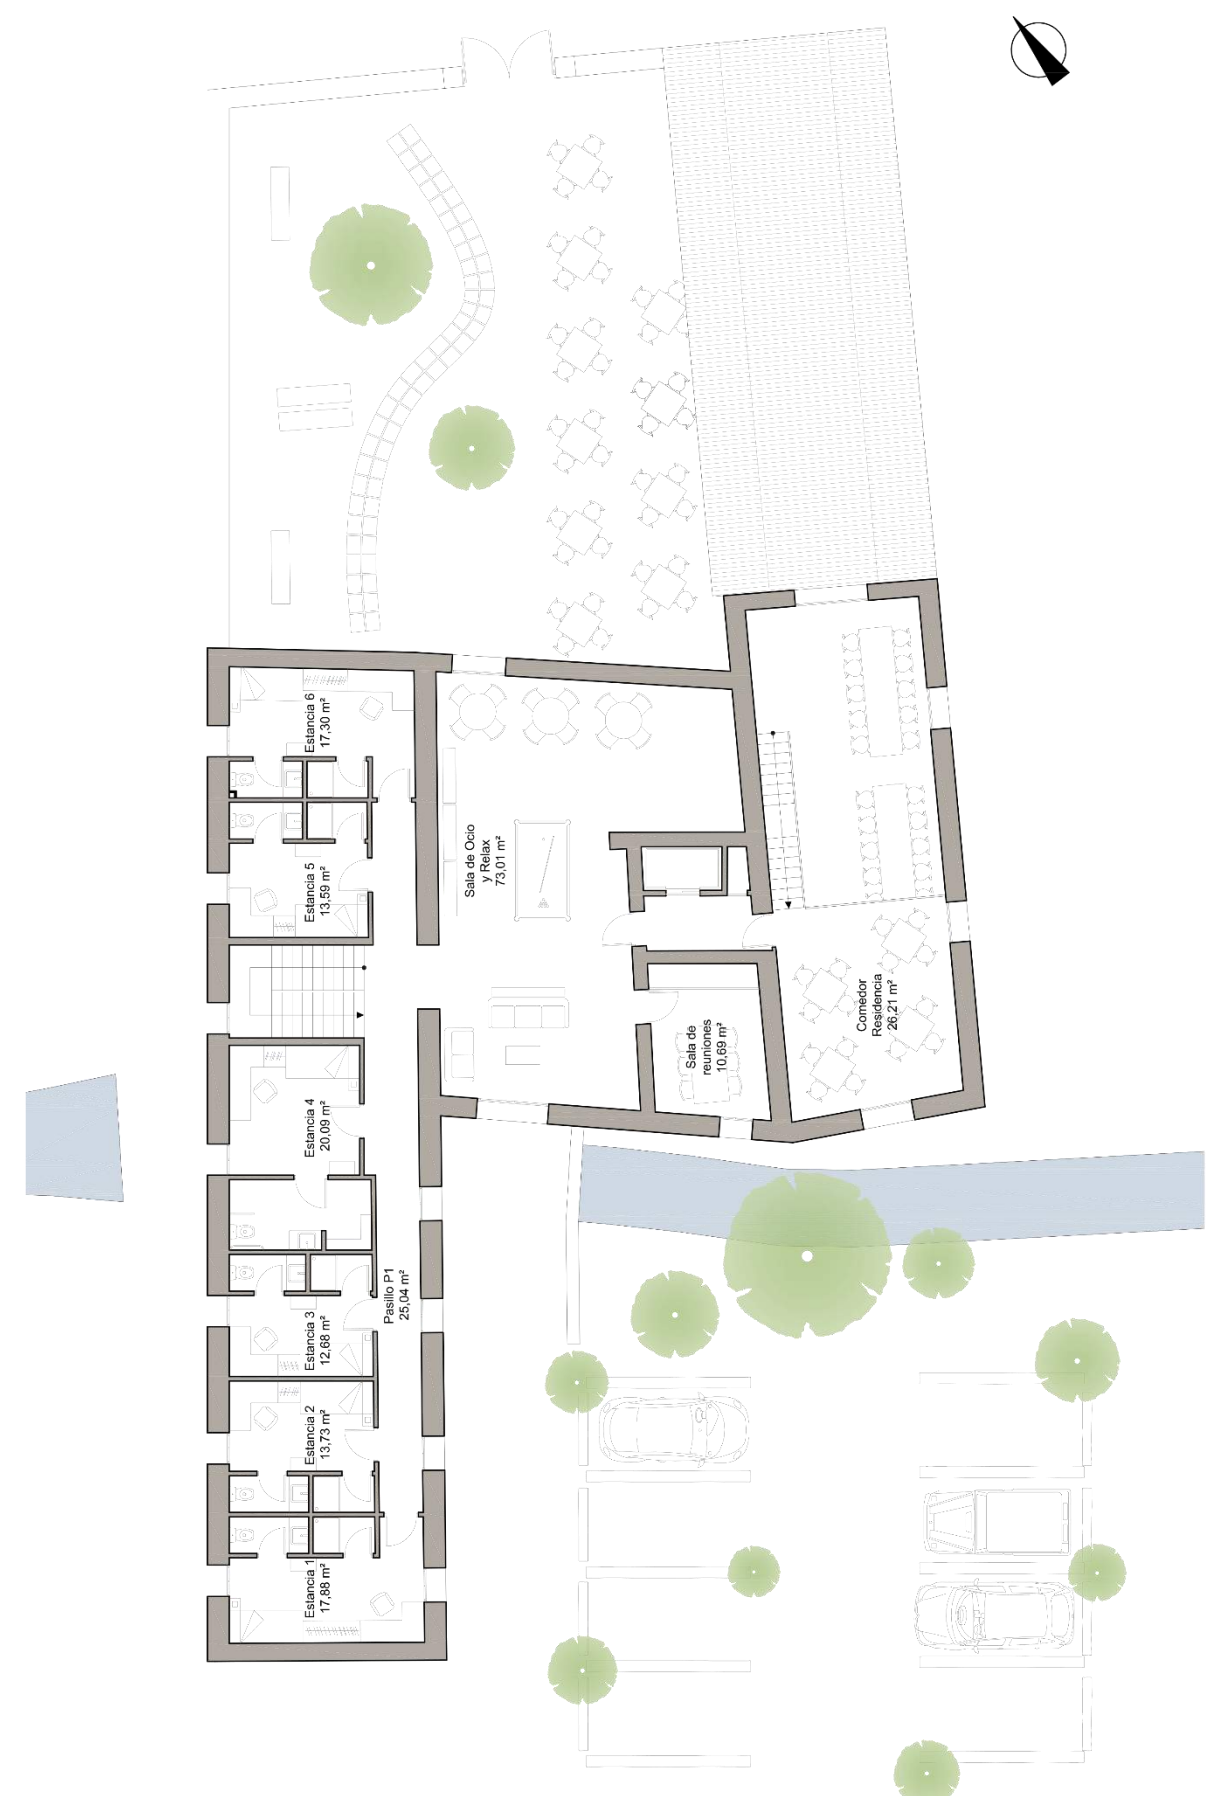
Estado Propuesto Alquería de Farinós. Planta Primera. Autor Propio. 2015.
